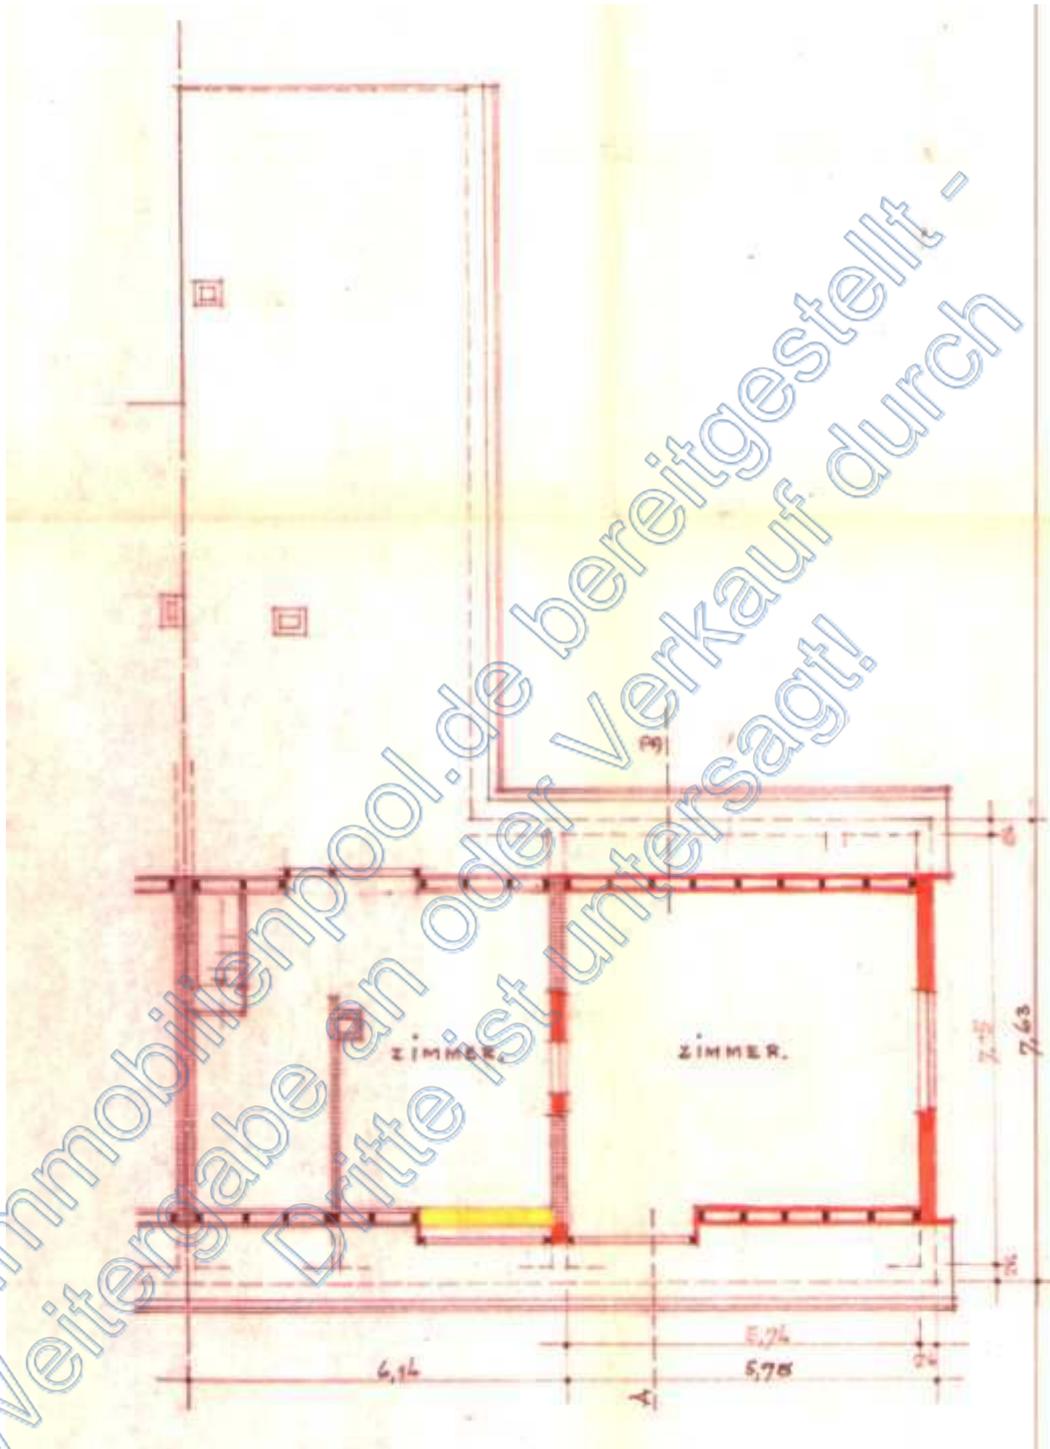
Grundrissplan Dachgeschoss (Vorderhaus), aus Bauakte 1970
